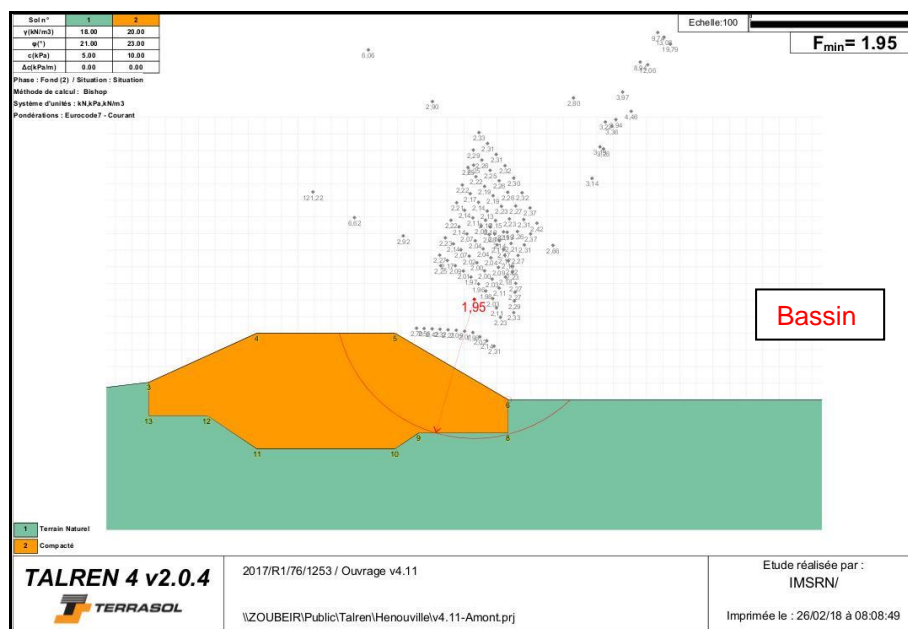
calcul de stabilité du remblai amont en situation fondamentale
